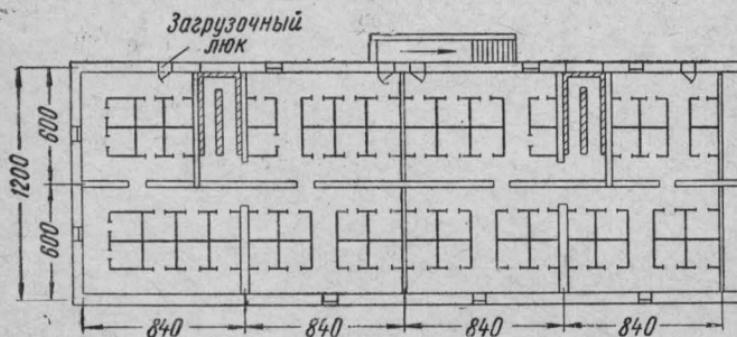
Типовое решение выходов из подвала жилого дома при размещении в нем дровяных и хозяйственных сараев
